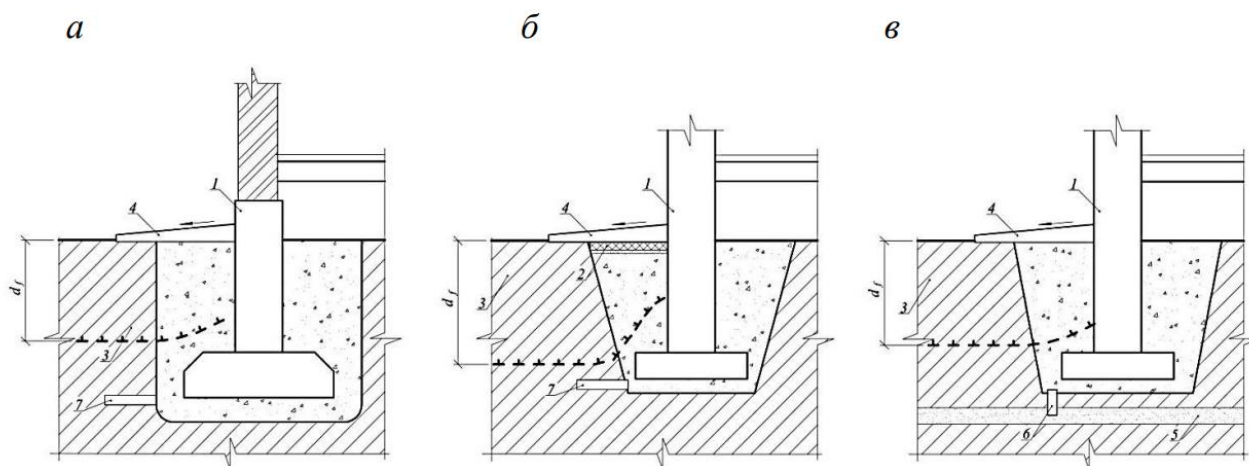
Виды дренажных сооружений у фундаментов: а – водоотвод ниже глубины сезонного промерзания; б – то же, при наличии слоя теплоизоляции; в – осушение грунта у фундамента с помощью дренажных скважин. 1 – фундамент; 2 – теплоизоляция; 3 – мерзлый грунт; 4 – отмостка; 5 – дренирующий слой грунта; 6 – дренажная труба; 7 – водоотводная труба.
